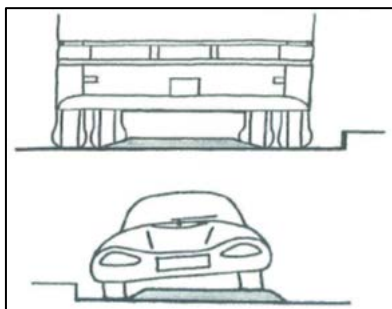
Coussins placés côte à côte sur une chaussée de 6,90 m de largeur
